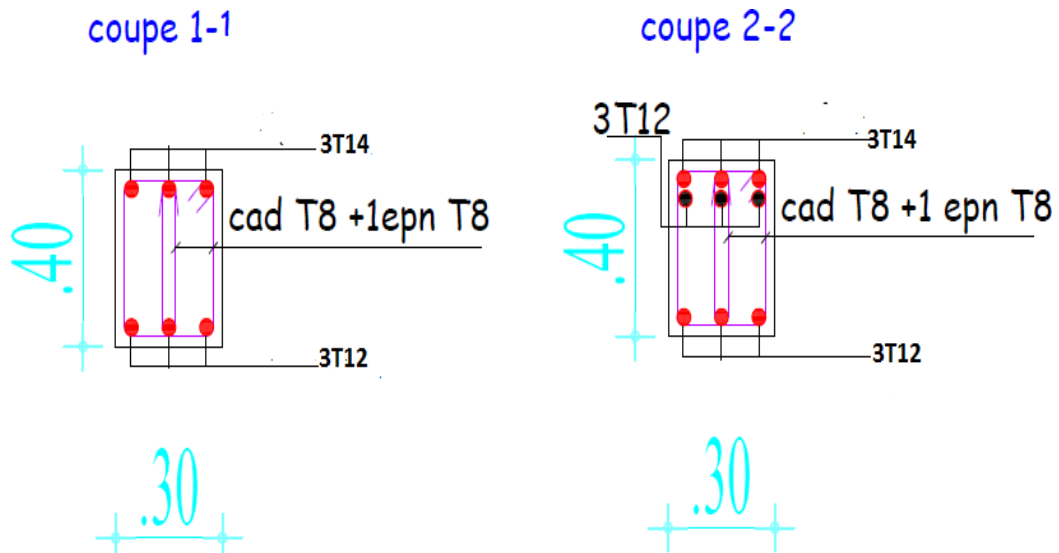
3: Schéma de ferrailage de la poutre principale (30x40) cm²
